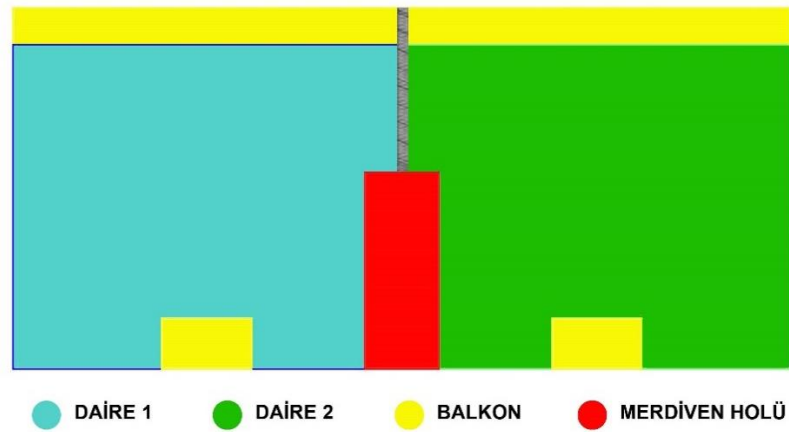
Meram Kampüs Alanı A Blok Planı
